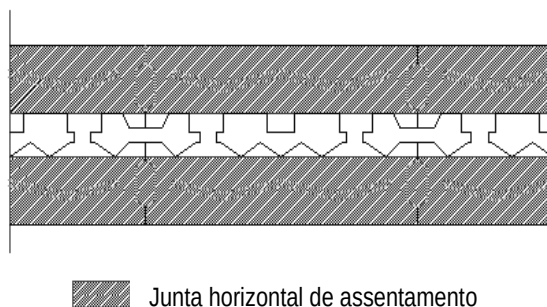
Pormenor esquemático de execução de junta horizontal de assentamento
